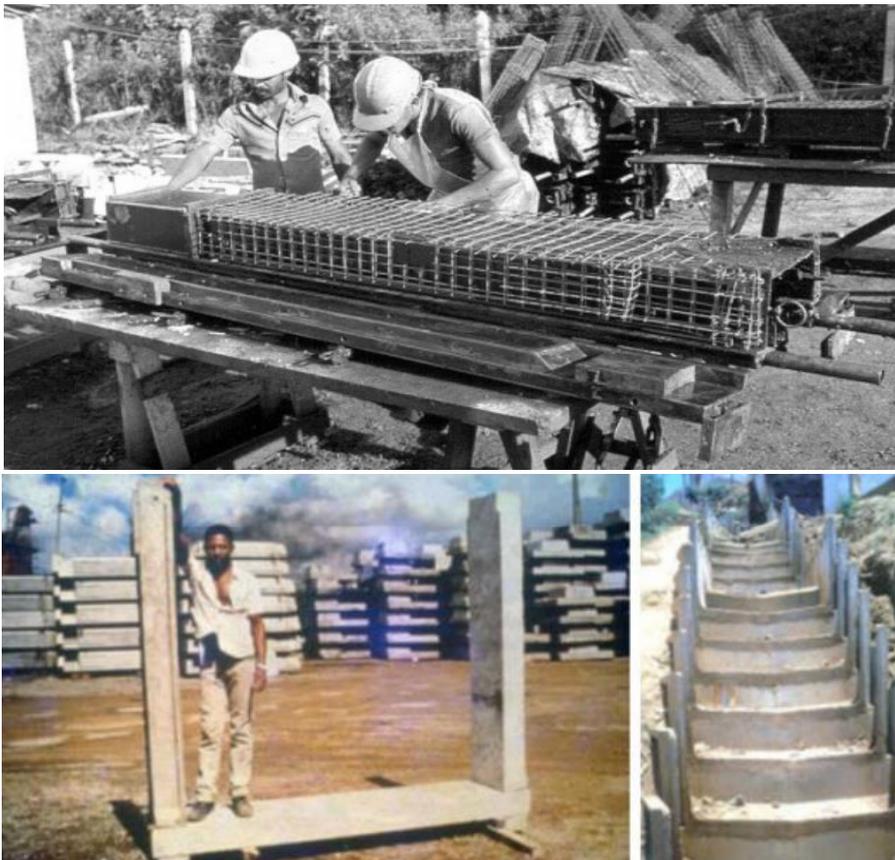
Armado de mallas de armaduras y almacenaje de piezas en fábrica RENURB
